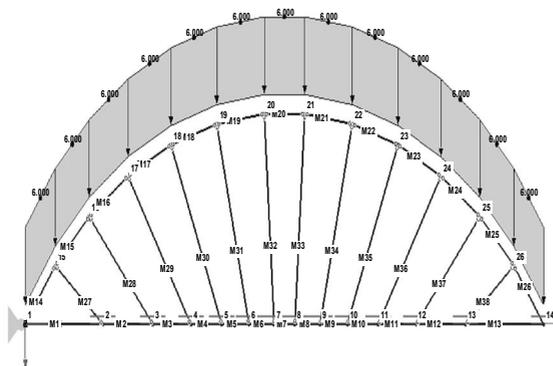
Расчетная схема индивидуальной металлической опорной системы
